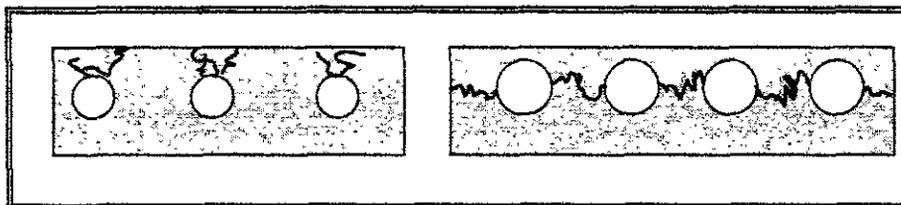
Daños ocasionados por el asentamiento plástico del concreto.
